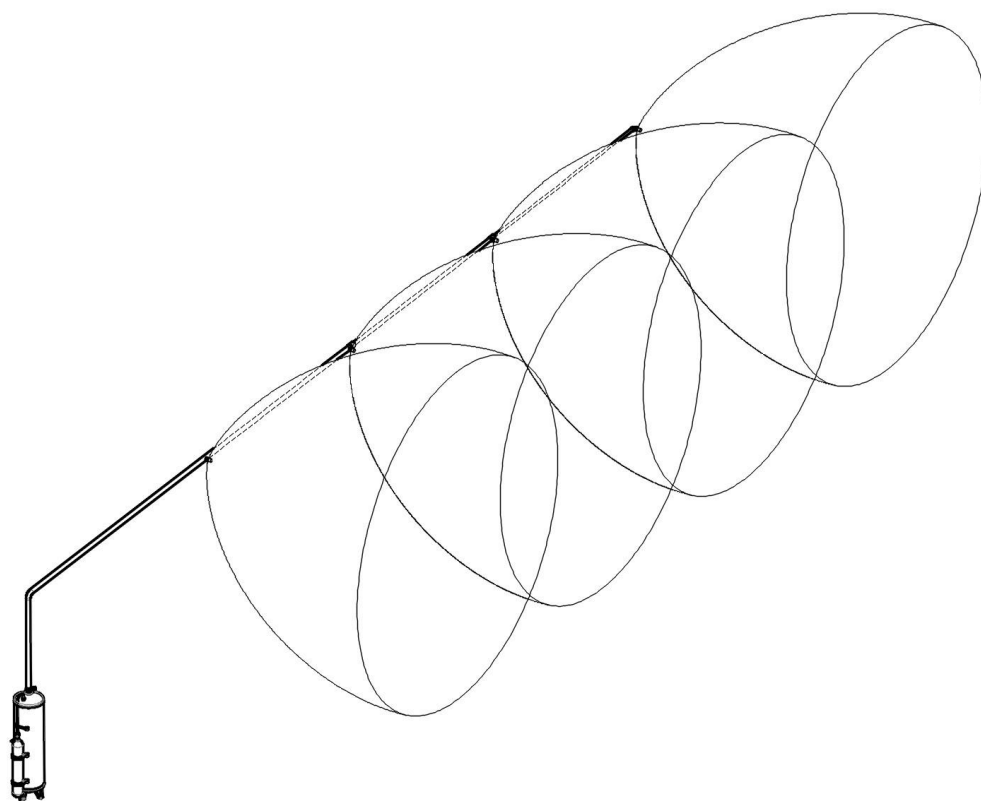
Схема подачи ТРВ под углом 90⁰ для орошения вертикальных поверхностей при горизонтальном размещении трубопровода из насадков НС-390-С или НС-360. Максимальная протяженность подводящего трубопровода составляет : для ТРВ-Гарант-160-10 не более 25м., включая вертикальную часть не более 8 м., ТРВ-Гарант-160-40 не более 70 метров, включая вертикальную часть не более 12 метров.
